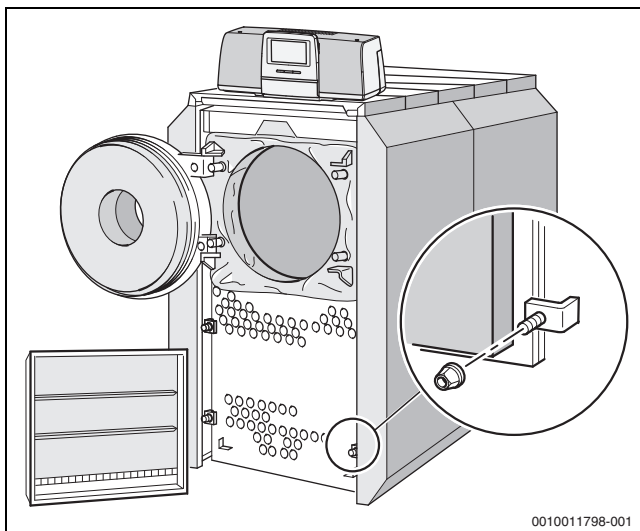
Retirer la chambre d'inversion et ouvrir la porte du brûleur
